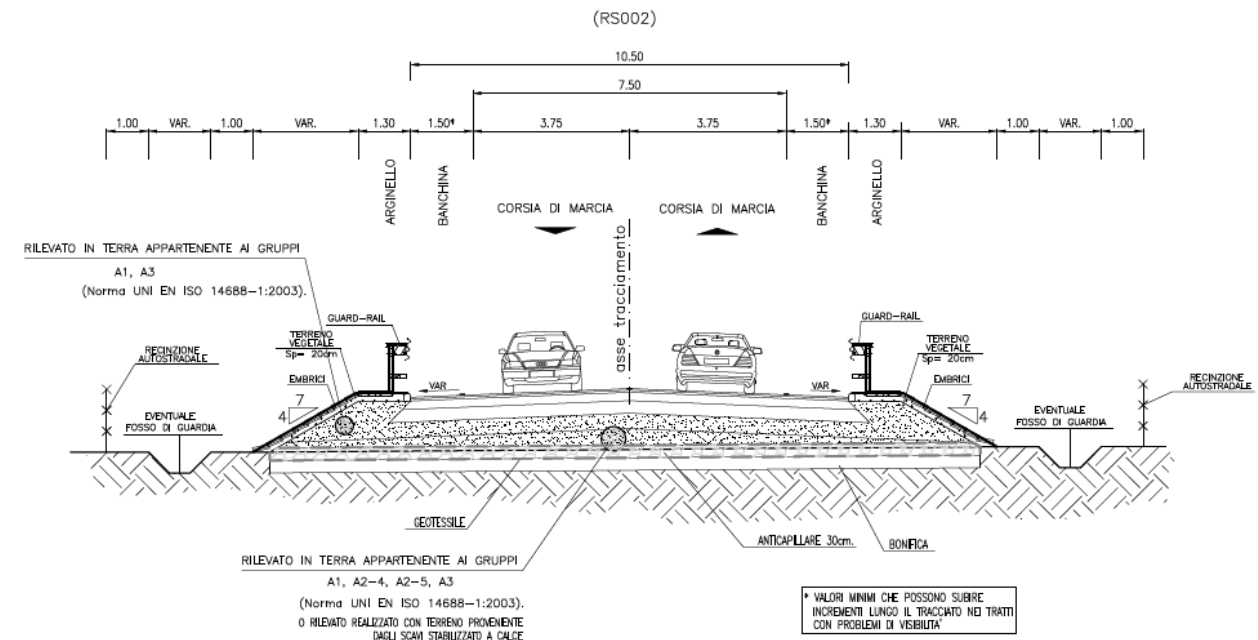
Sezione tipo rampa bidirezionale RS002
